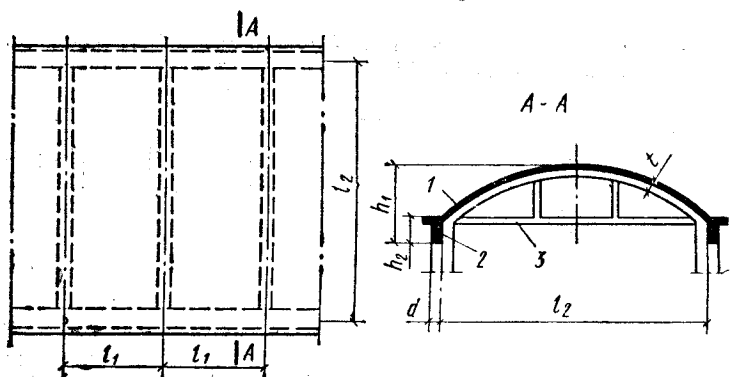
Конструктивная схема монолитной короткой цилиндрической оболочки
